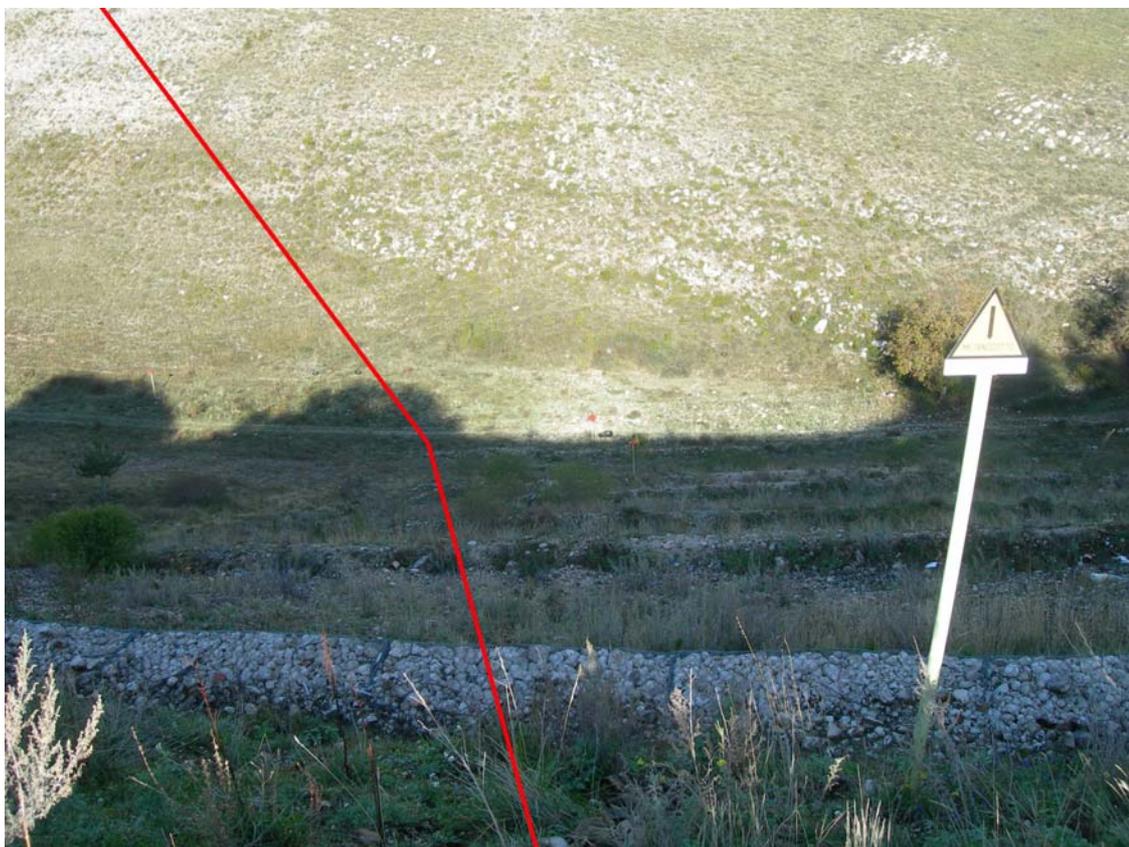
/O: Particolare della discesa della condotta nell'area a rischio elevato R3.
